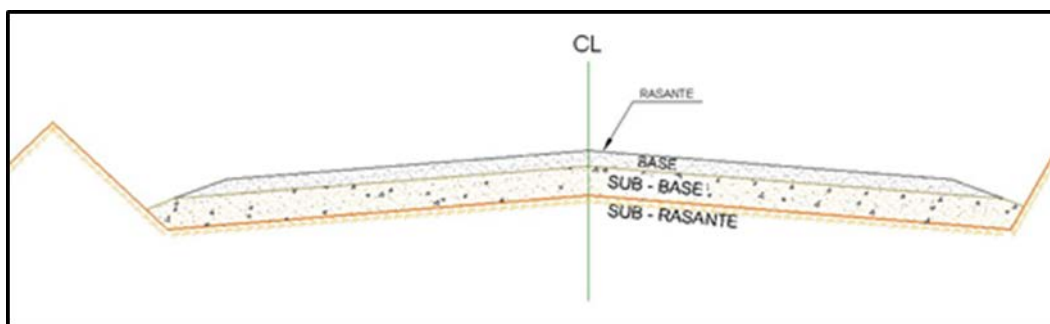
Sección Teórica, Típica de un Pavimento en una Vía de Acarreo de MYSRL
